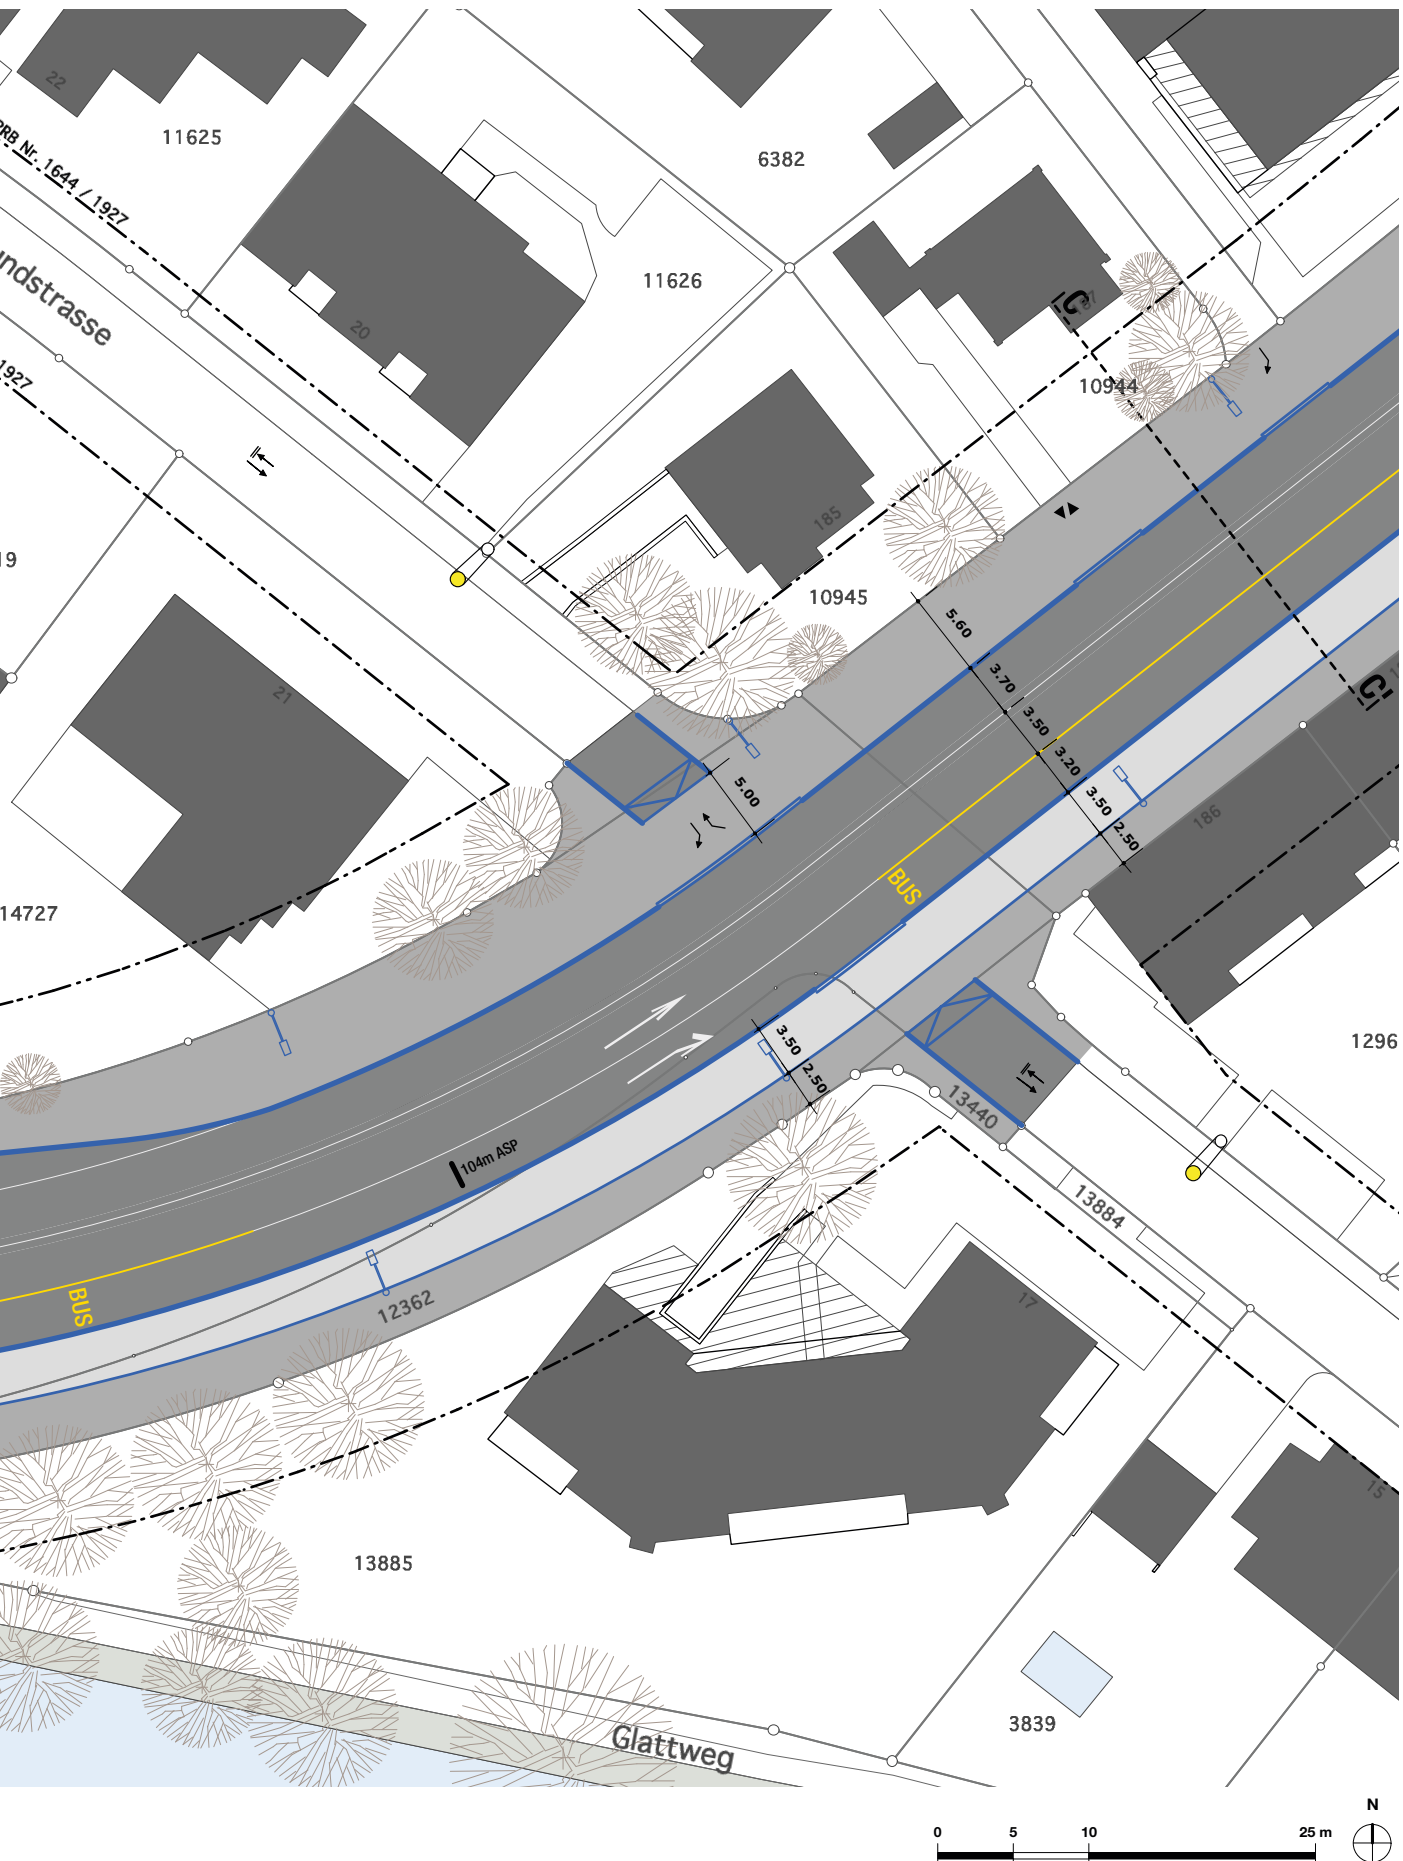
Situationsplan Ausschnitt 2 1:500
